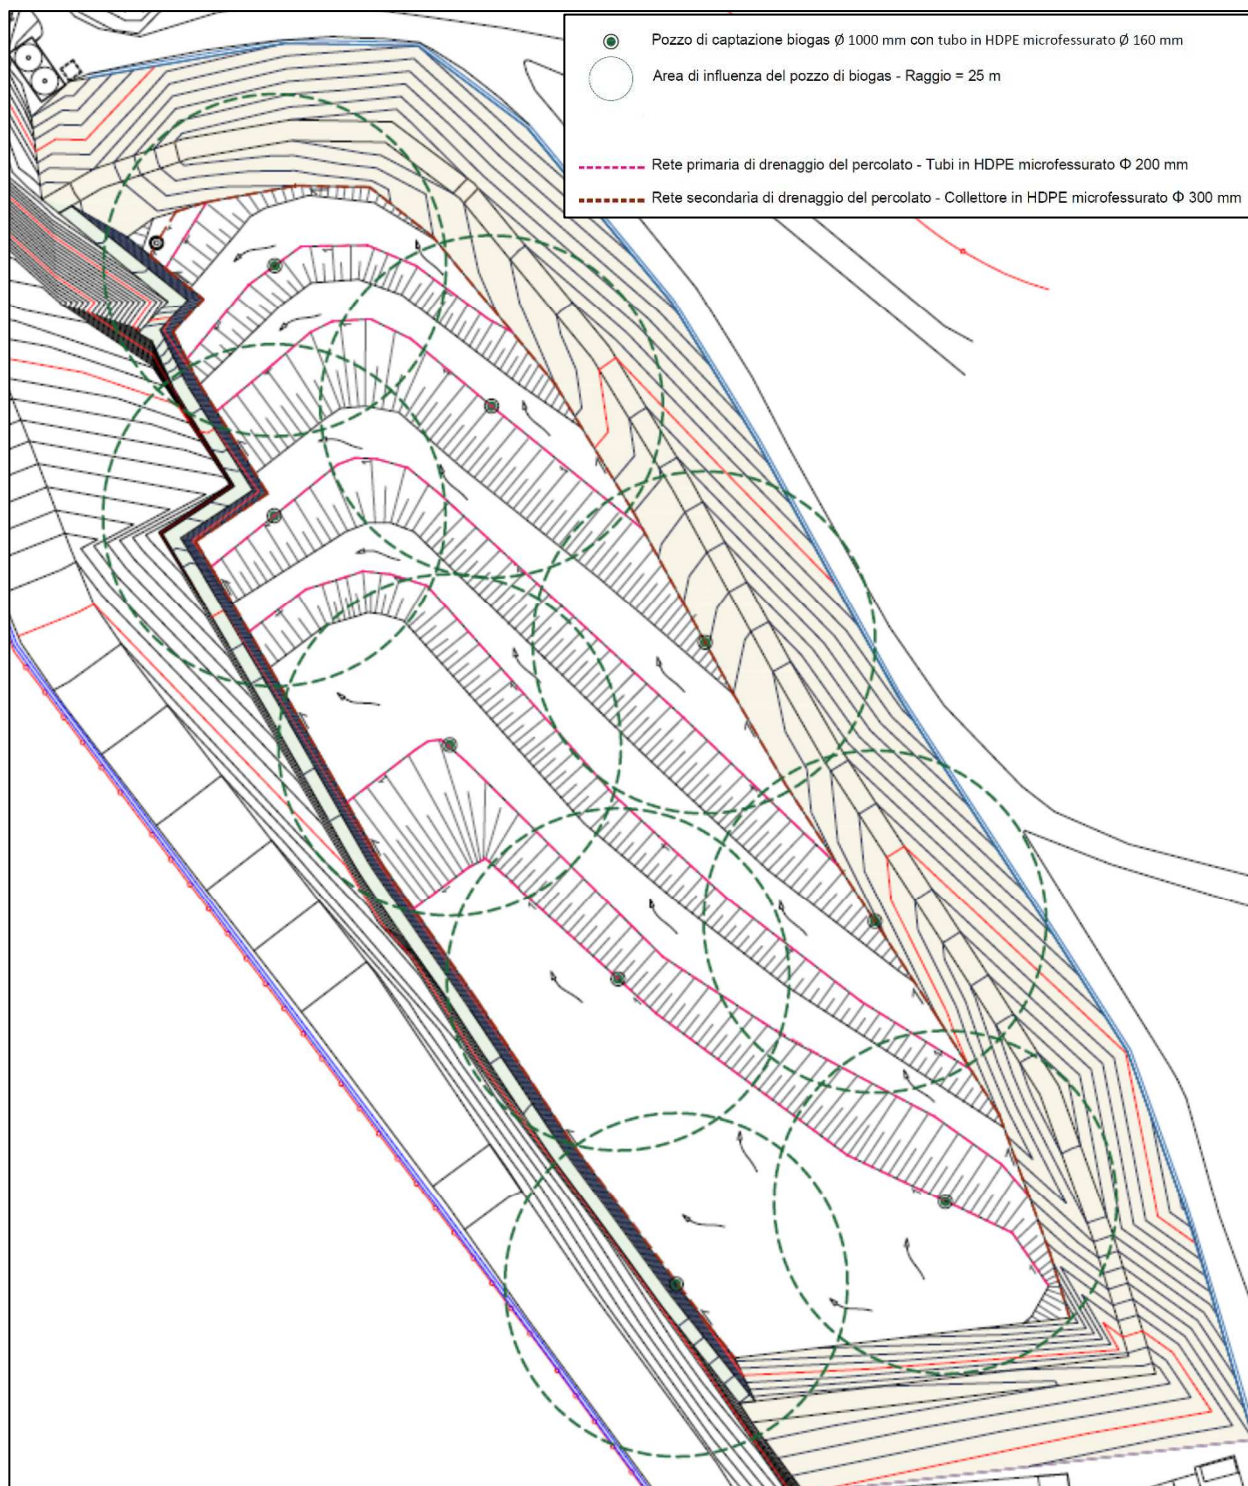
/XXV: Distribuzione planimetrica dei pozzi di biogas
